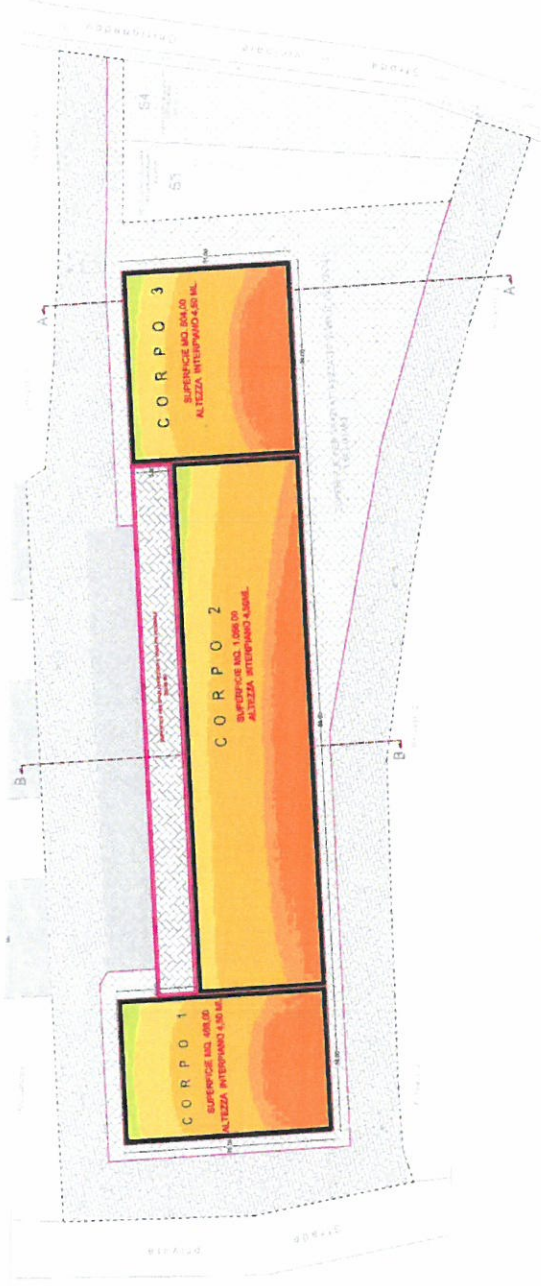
Planimetria della lottizzazione – Stato di progetto (rif. Tav. 5)
